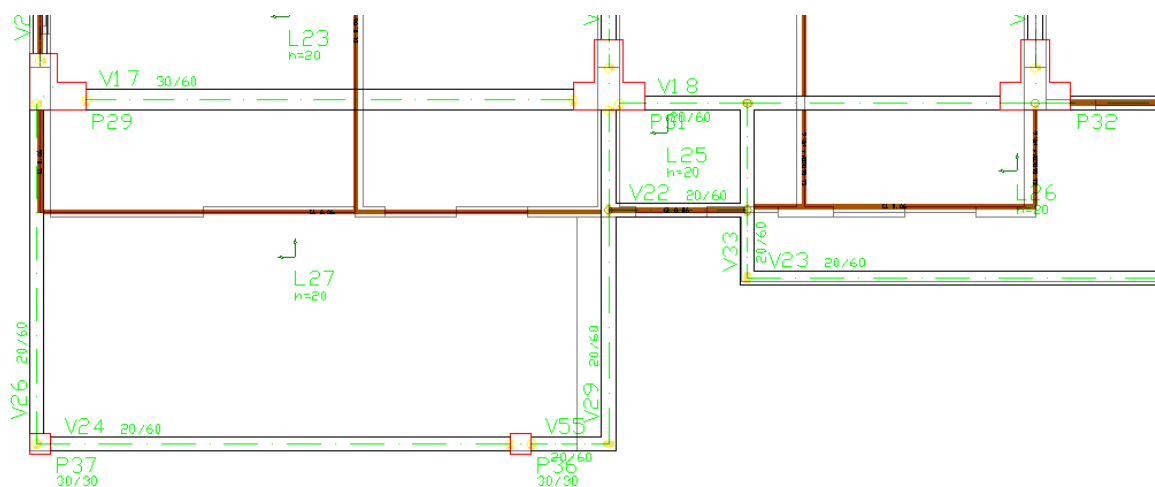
Pavimento PT1 da Solução Convencional com adição dos pilares P36 e P37
